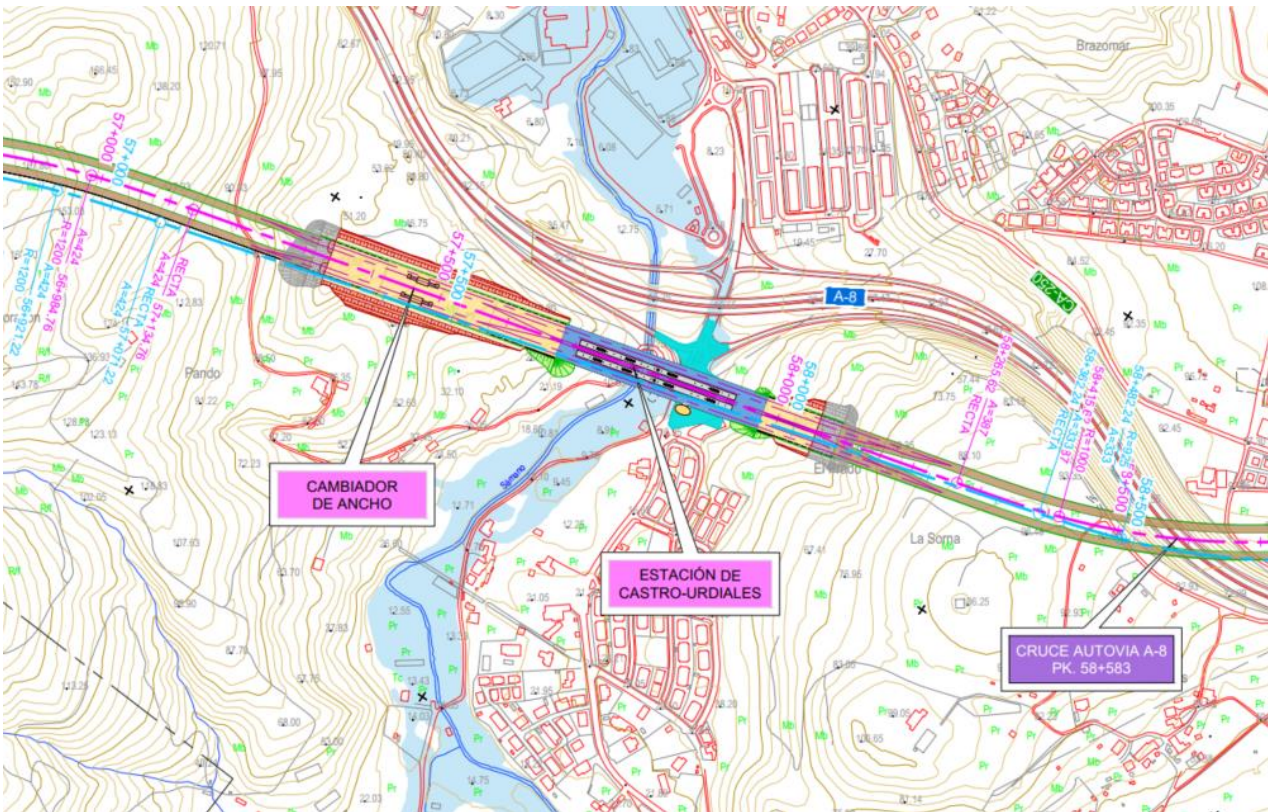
Planta Alternativa A1 rasante baja (color rosa) frente rasante alta (color azul)
